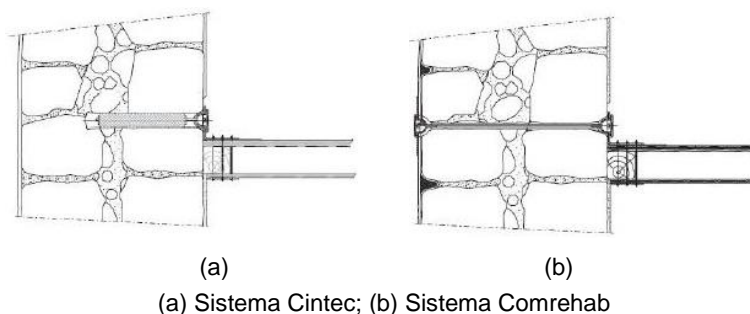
Fixação de perfis metálicos ao pavimento e à parede [14]
